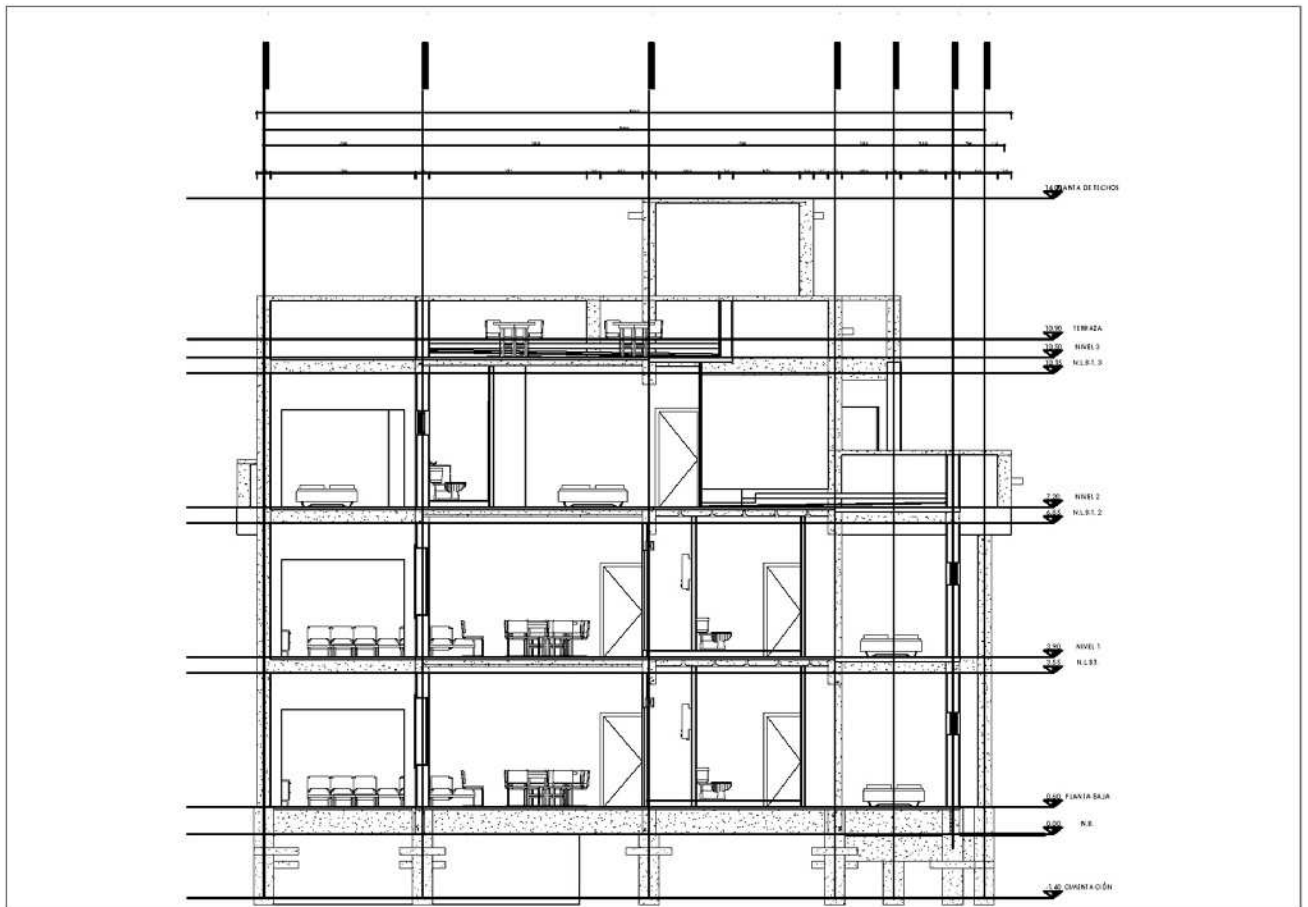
Corte transversal "A" del proyecto para la construcción de departamentos Villas Holx
